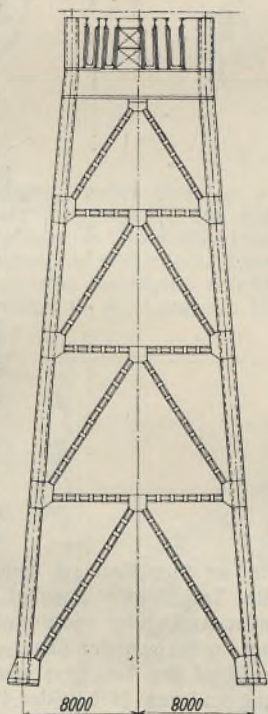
Ansicht a-b der Fachwerkstrebe. (vergl. Abb. 1 rechts).
